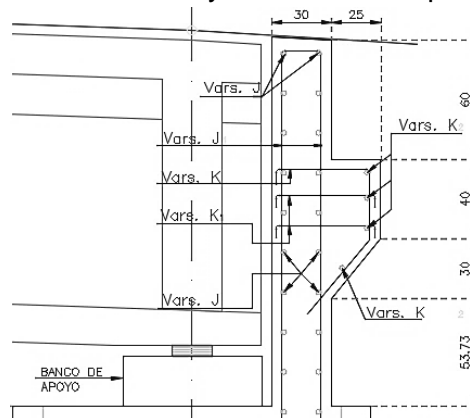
Dimensiones y armado de muro de respaldo en apoyo extremo.
